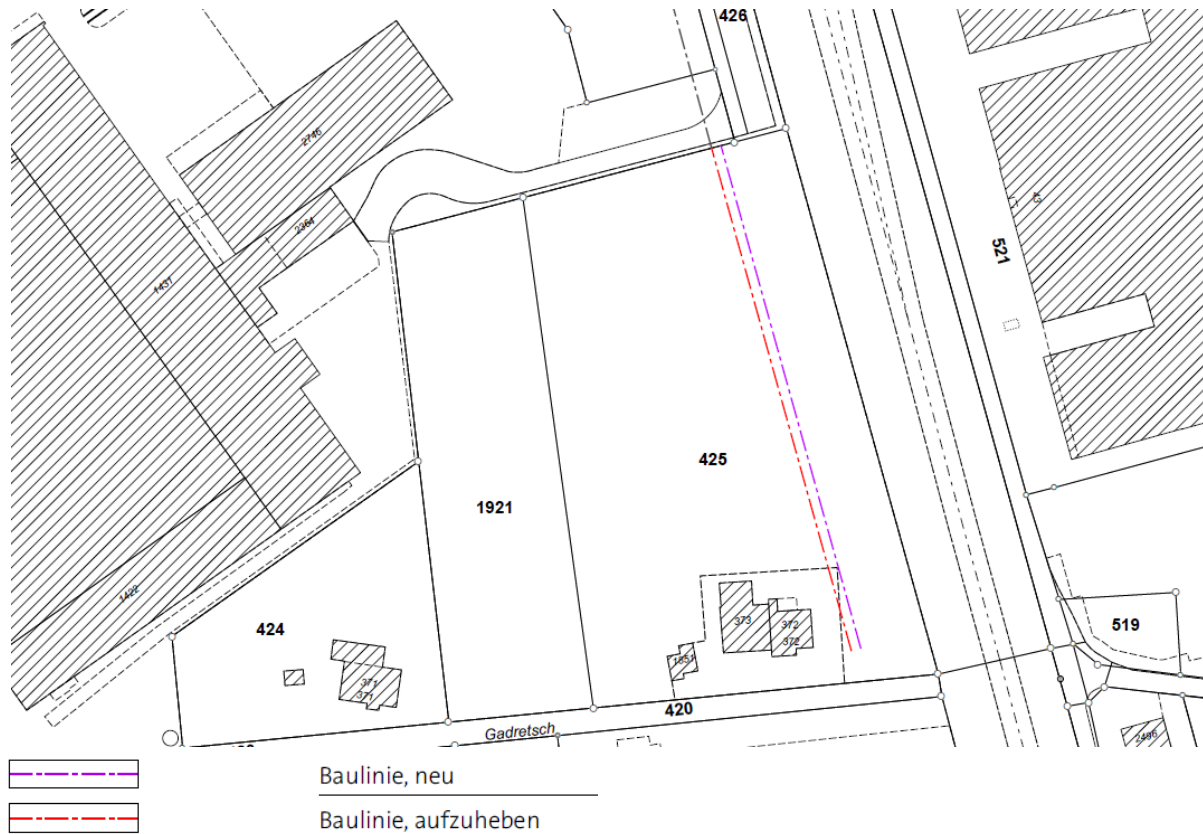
Ausschnitt 2. Änderung Baulinienplan
